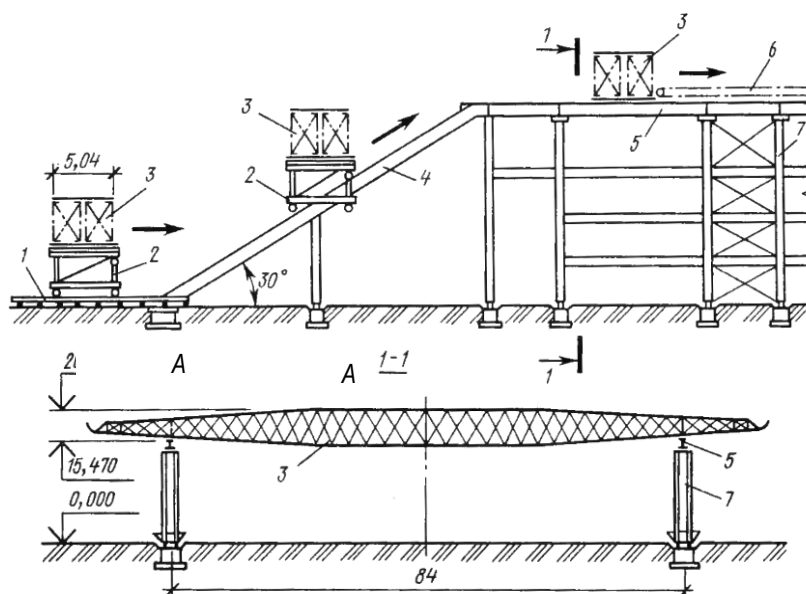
Схема монтажа блока покрытия спорткомплекса ЦСКА надвижкой:
